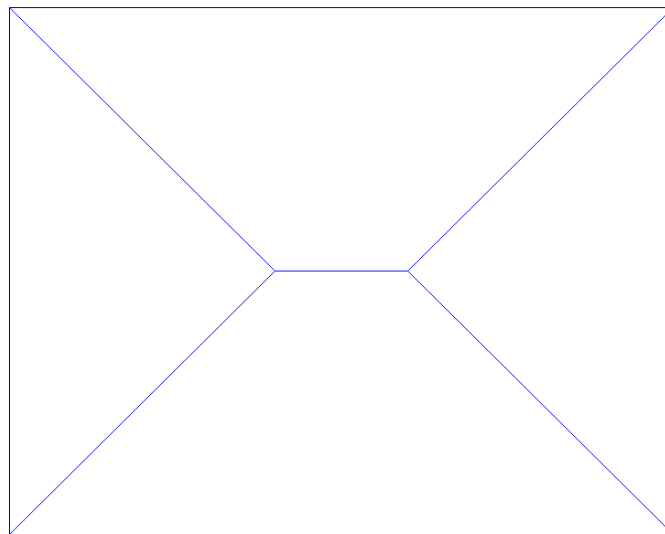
Divisão da laje em forma de telhado, para cálculo de transmissão de cargas das lajes para as vigas
